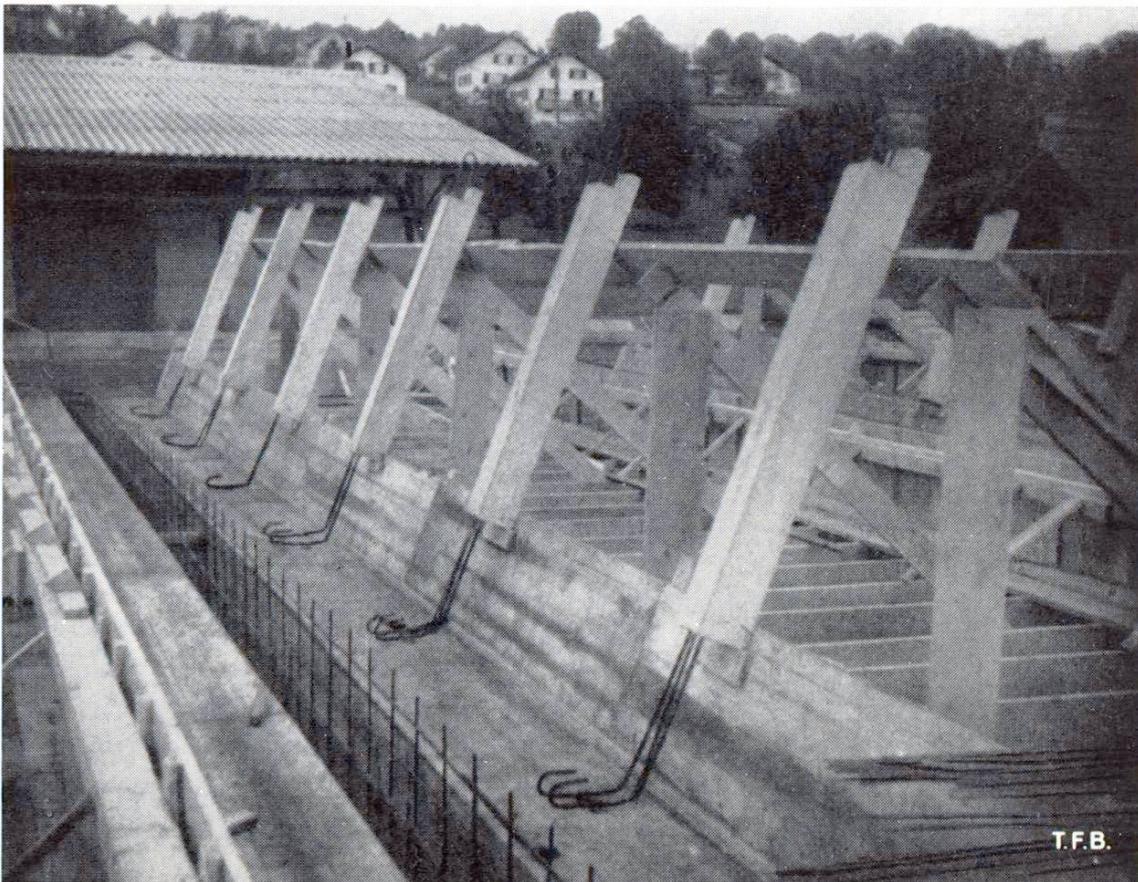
Armature d'une poutre en gouttière. Les poinçons sont maintenus en place par un échaffaudage
